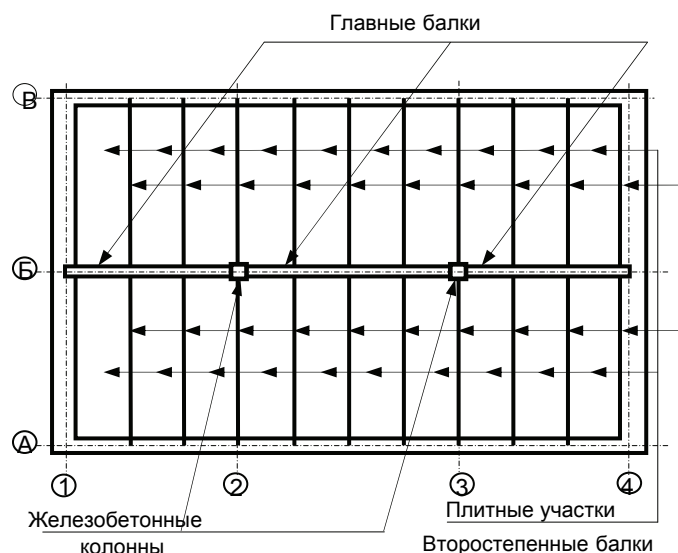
Схема раскладки элементов железобетонного монолитного перекрытия
